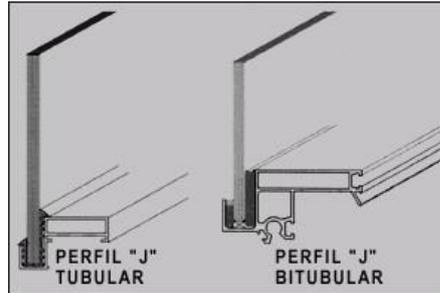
Perfis quadro fachada Stick encaixilhado
